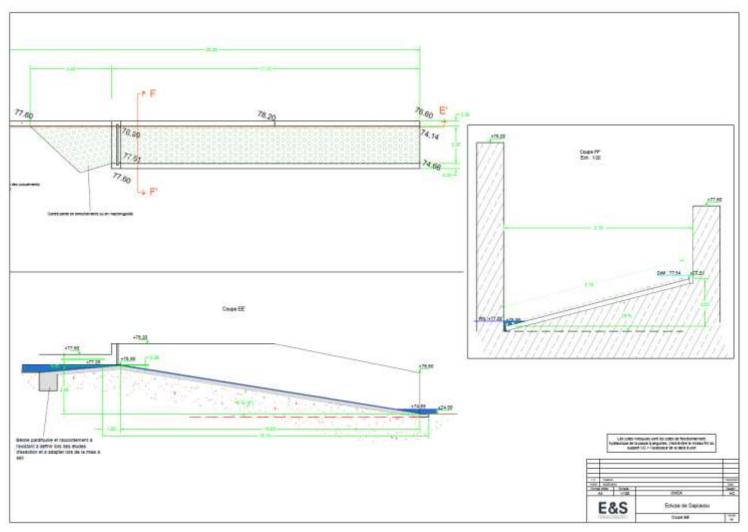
Plan de principe de la passe à anguilles et profil en travers
